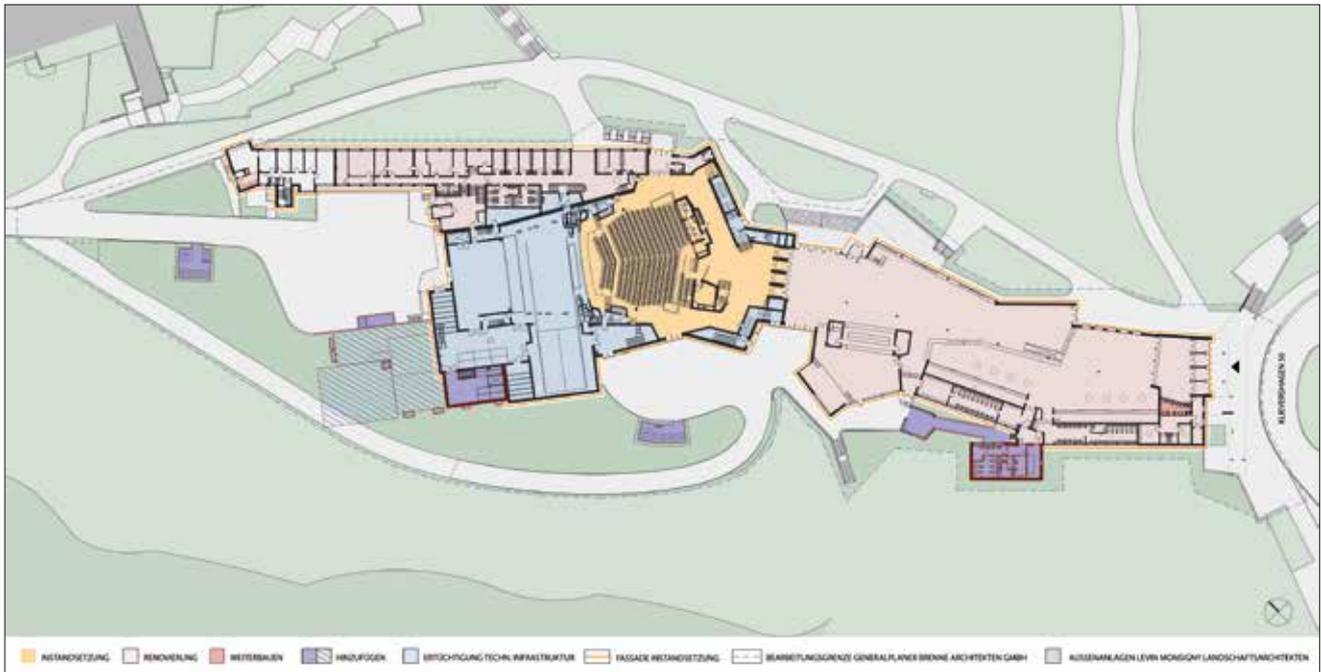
Grundriss Sanierungsmaßnahmen 2016
